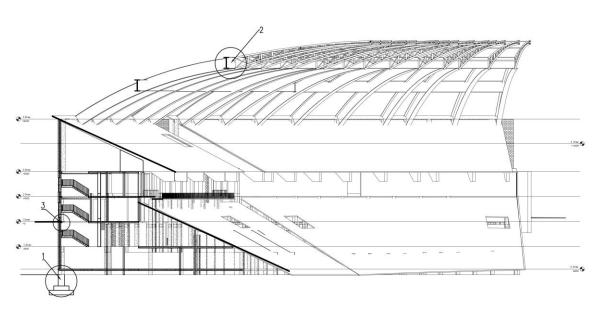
Разрез по лестнице с замаркированными разработанными узлами (Чертеж автора)
